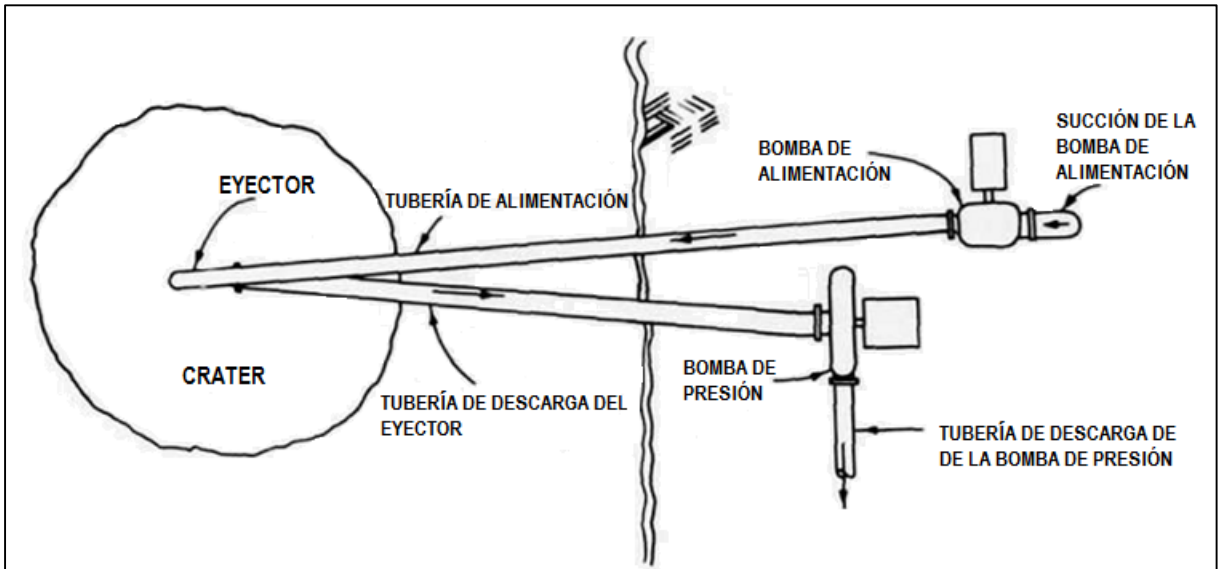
Vista en planta de los elementos de un SBA (Richardson y McNair 1981)
